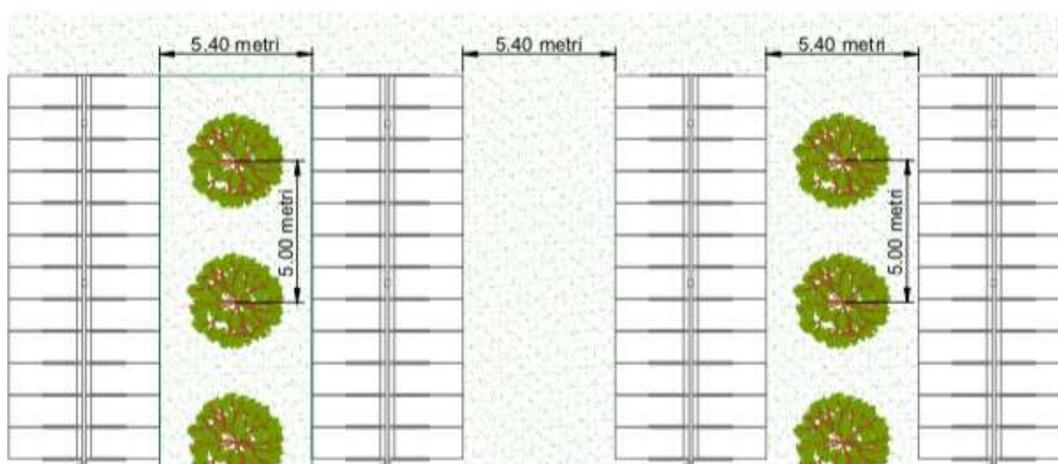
Vista in pianta della disposizione dell'oliveto a file alterne
